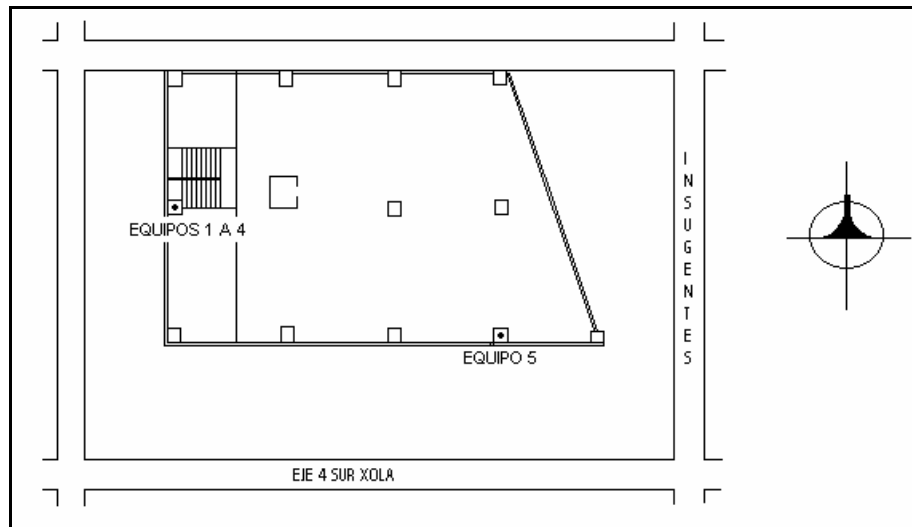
Planta tipo del edificio y ubicación de equipos de medición.
